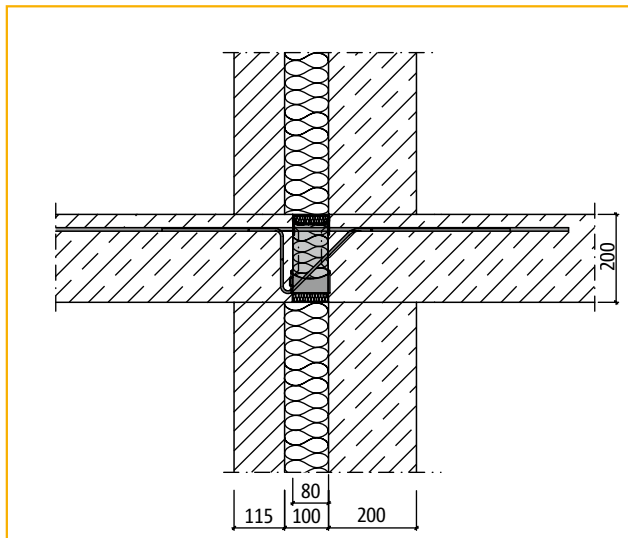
а: Соединение балконной плиты с использованием Schöck Isokorb® тип K30-CV30 для системы с теплоизоляцией
